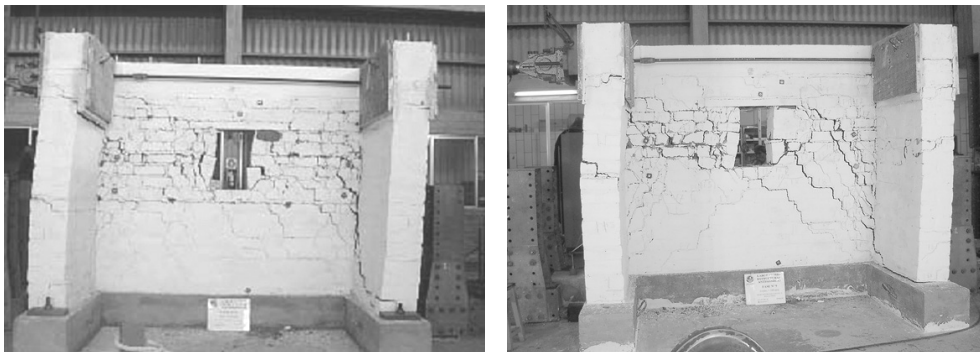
Muro reforzado con PVC vs. muro reforzado con caña
